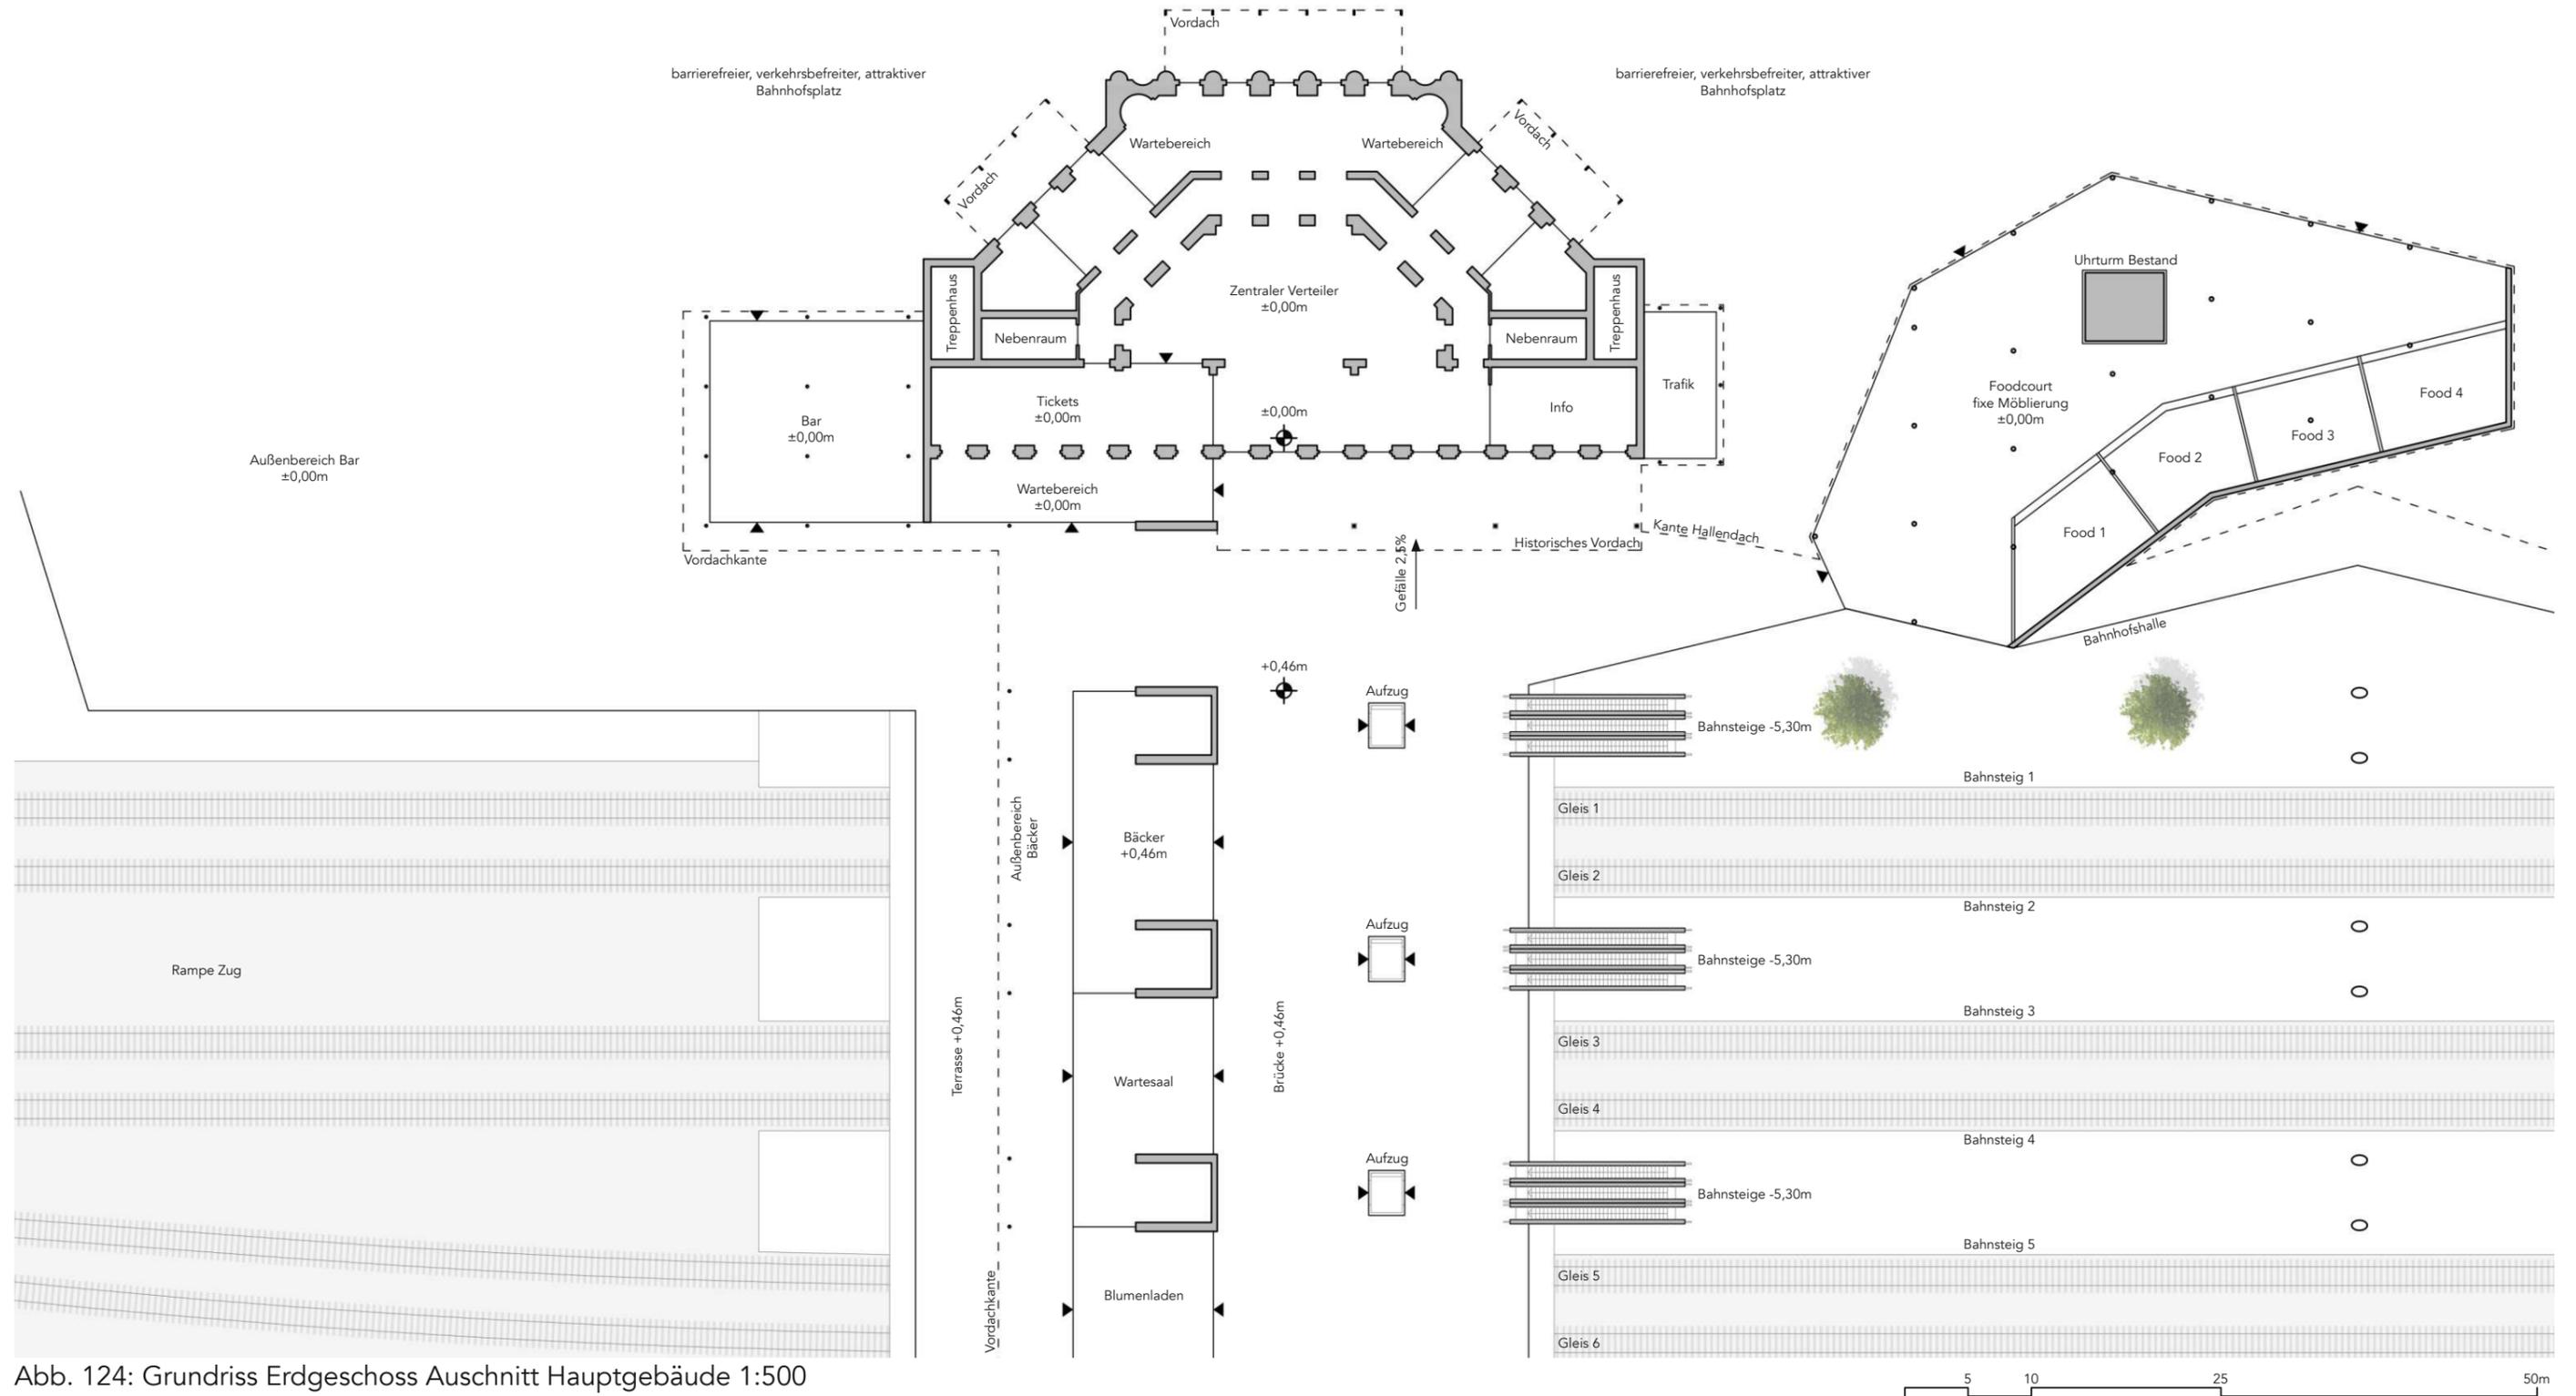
Grundriss Erdgeschoss Ausschnitt Hauptgebäude 1:500
